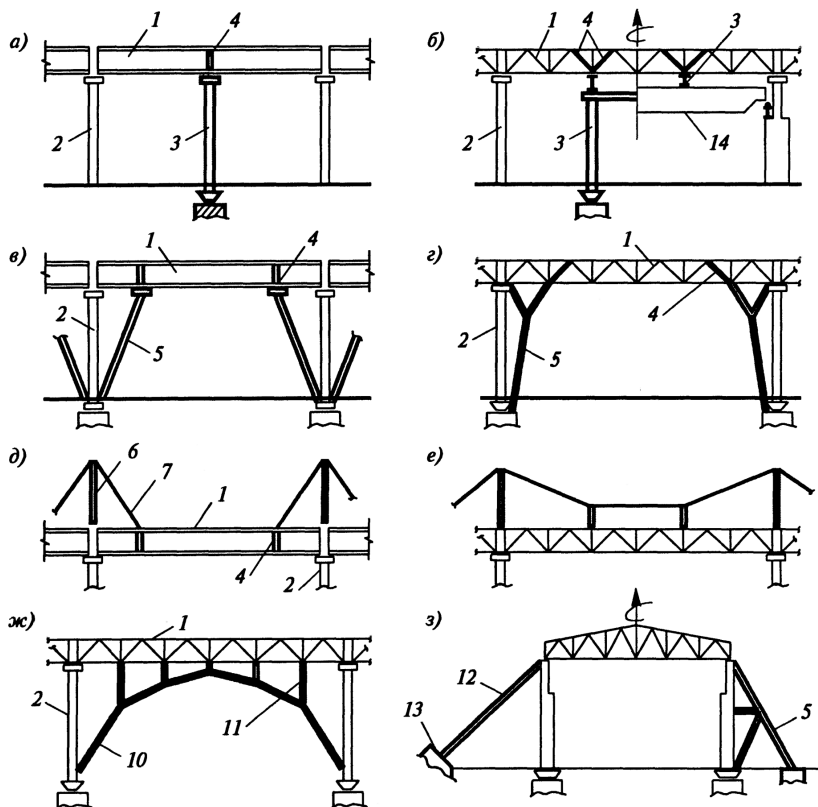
Усиление конструкций подведением (установкой) дополнительных опор: 1 – усиливаемая конструкция; 2 – существующая опора; 3 – новая опора; 4 – элемент местного усиления; 5 – новый подкос; 6, 7, 8, 9 – соответственно дополнительные пилон, вант, несущий трос, подвеска; 10, 11 – дополнительные арка и стойка; 12, 13 – соответственно новые оттяжка и фундамент; 14 – мостовой кран
